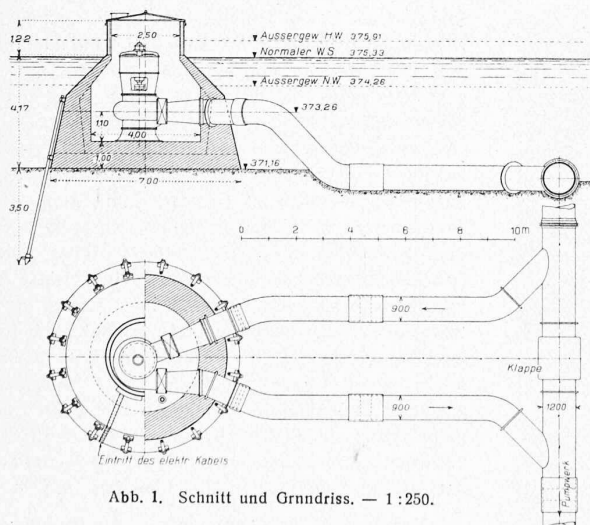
Schnitt und Grundriss. — 1:250.
